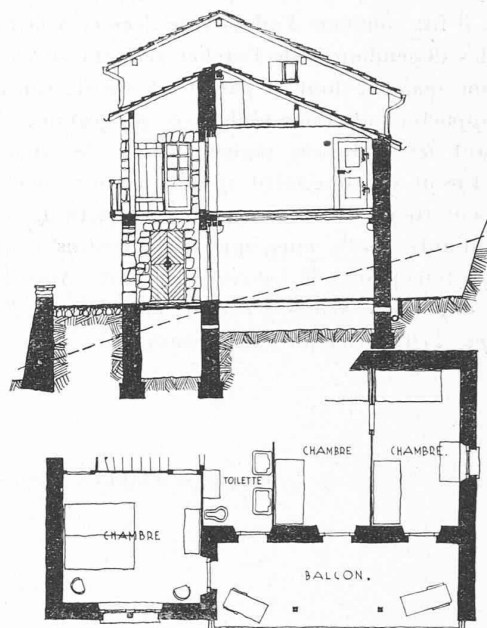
Vouga : Coupe et plan du 1^{er} étage.
